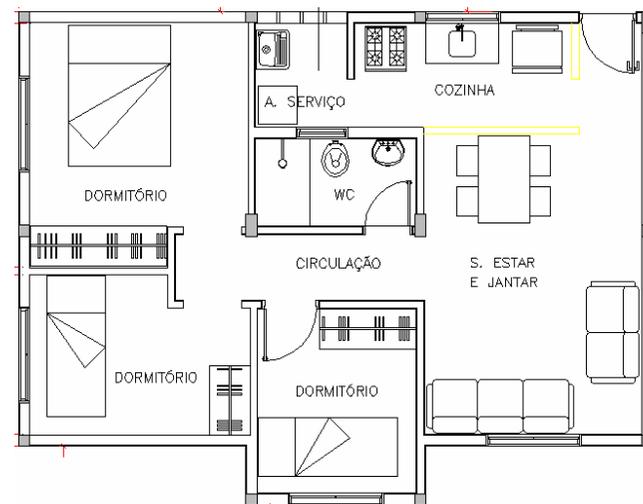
Layout do apartamento tipo na segunda versão do projeto (sem escala). Fonte: PMB, 2004.
